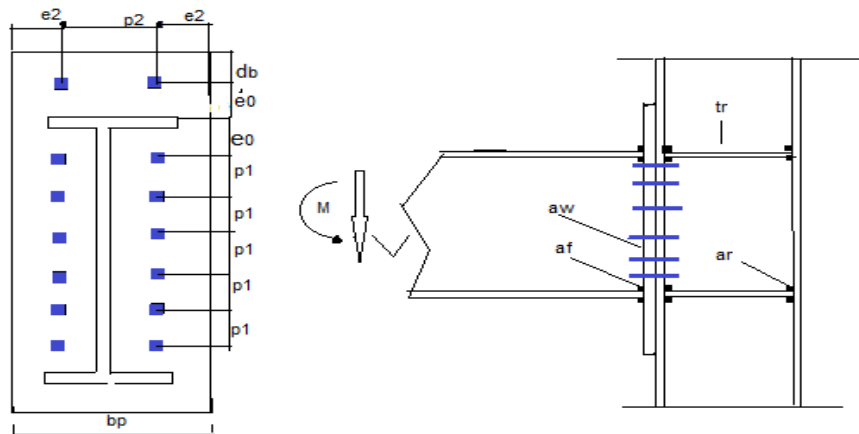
schéma de l' assemblage poteau – poutre à vérifier .
